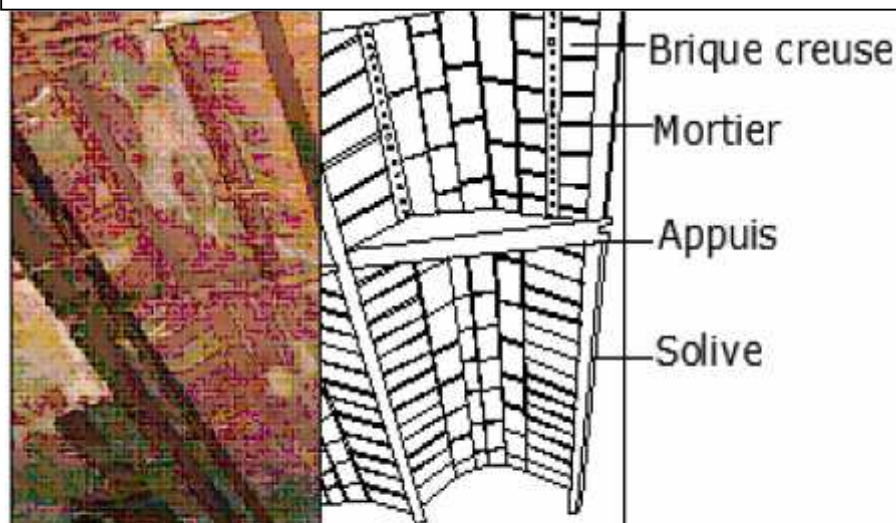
Plancher à voutain avec brique creuse et faux plafond
